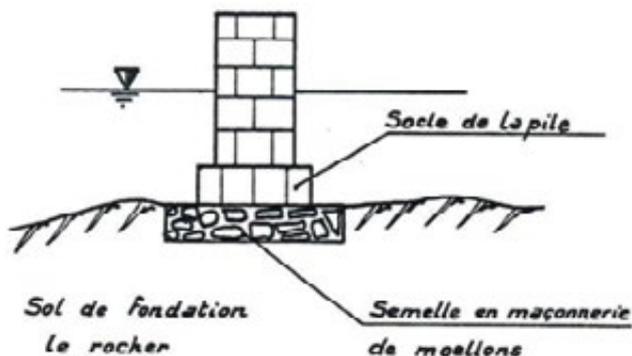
Semelle de fondation en maçonnerie de moellons hourdés au mortier de ciment (crédit J-P Levillain)
